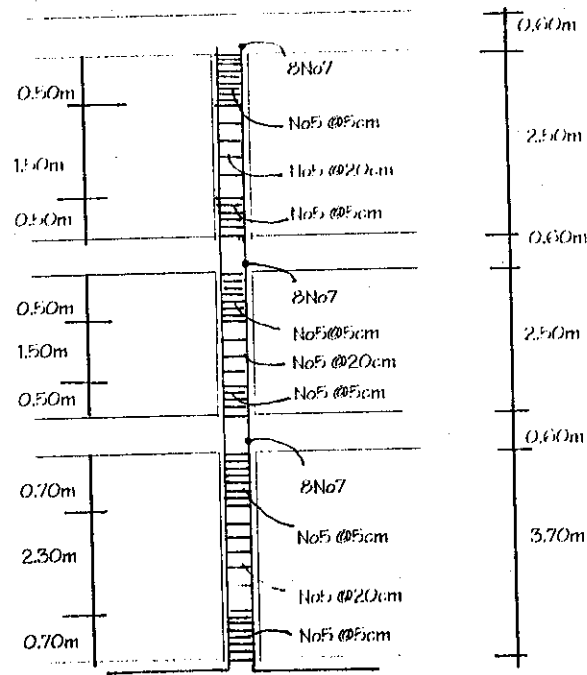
DETALLE EN COLUMNAS INTERMEDIAS MARCO B
